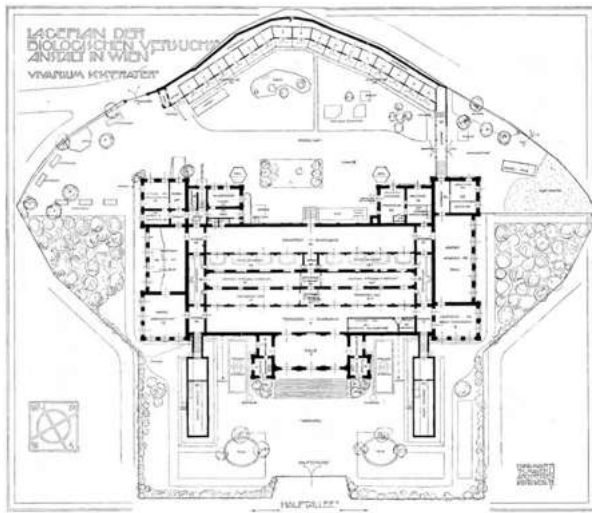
Lageplan der BVA, spätere Kopie in Przi Bram (1910)
